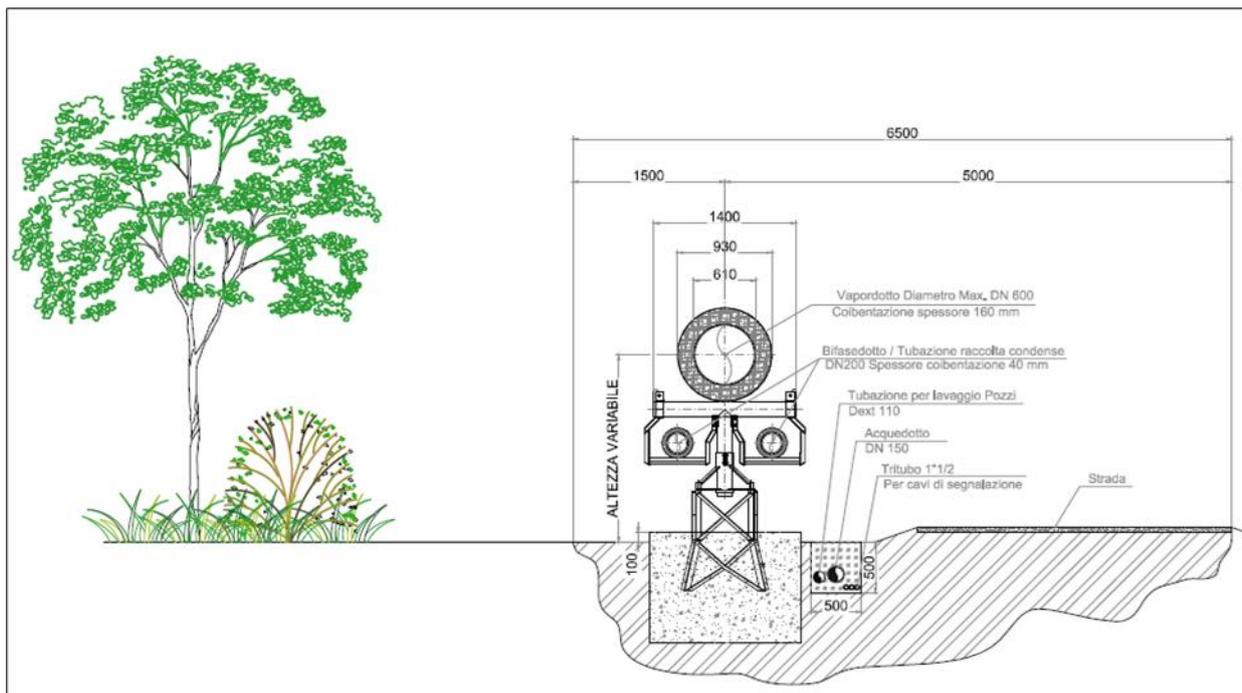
Tipico posa rete fluidi (caso con strada adiacente)
